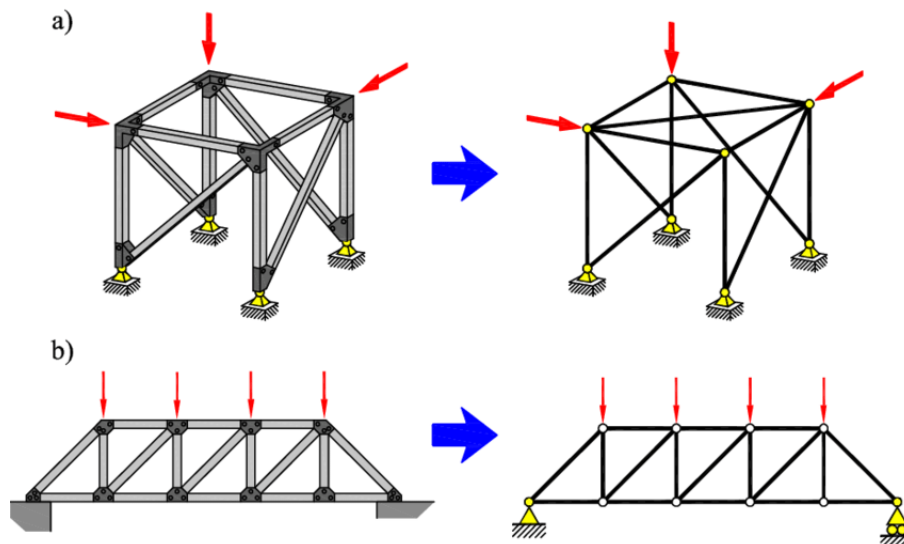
Estructuras de barras articuladas espacial (a) y plana (b). Fuente: "Mecánica de estructuras" Miguel Cervera Ruíz, Elena Blanco Díaz.
